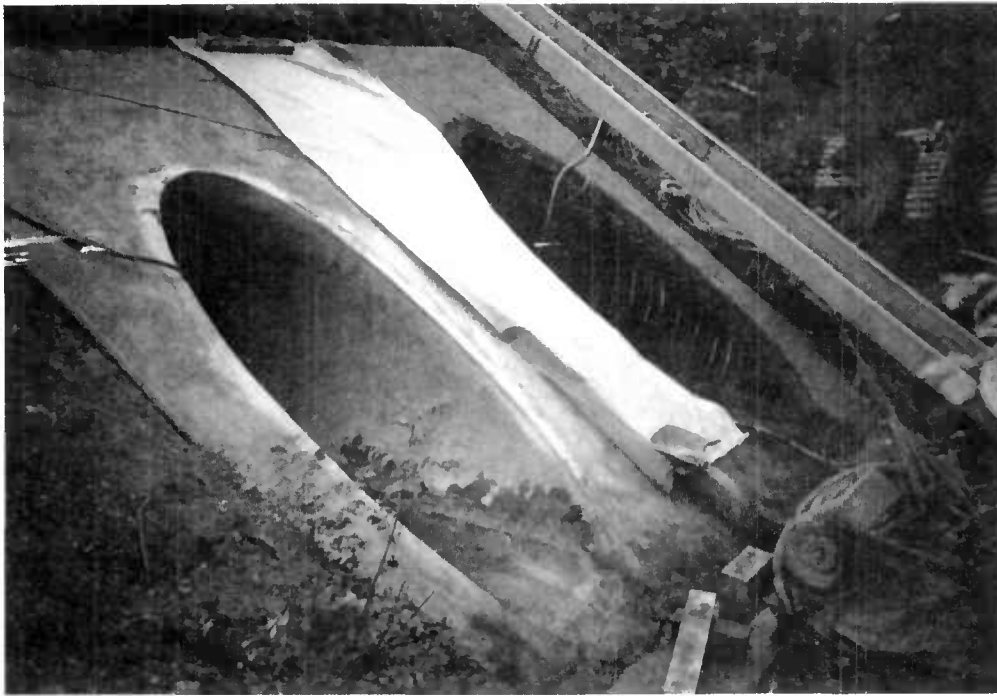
Renforcement d'un ouvrage par béton projeté
